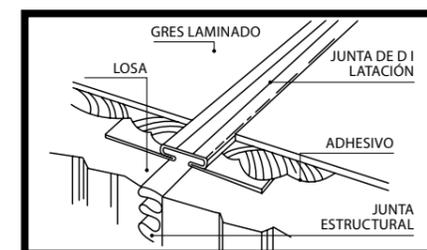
En las juntas estructurales del fondo es obligatorio realizar juntas de dilatación de un ancho no inferior al existente.
